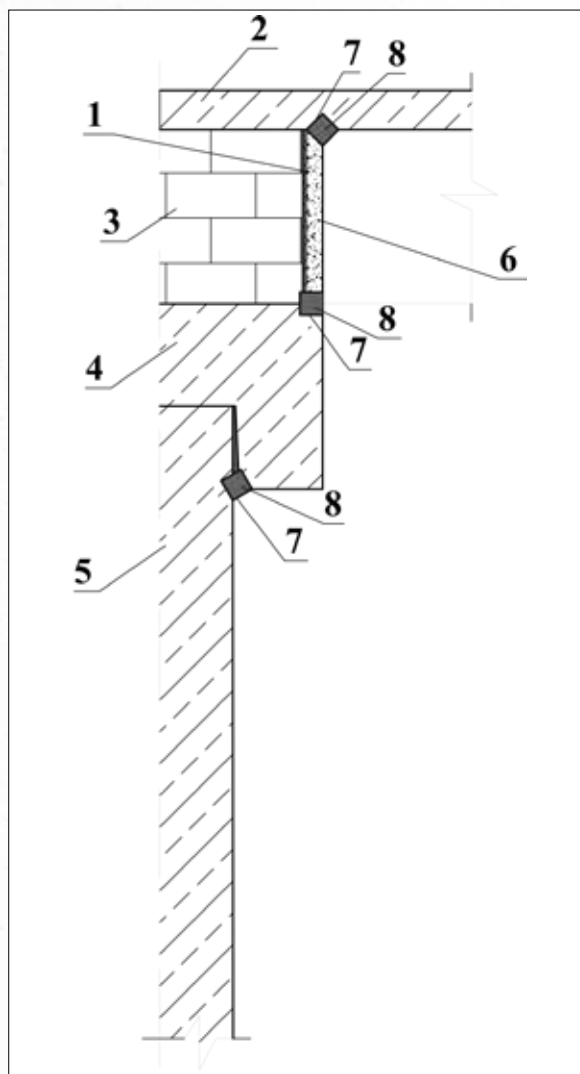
Схема гидроизоляции примыкания стеновых панелей к плитам перекрытий:
